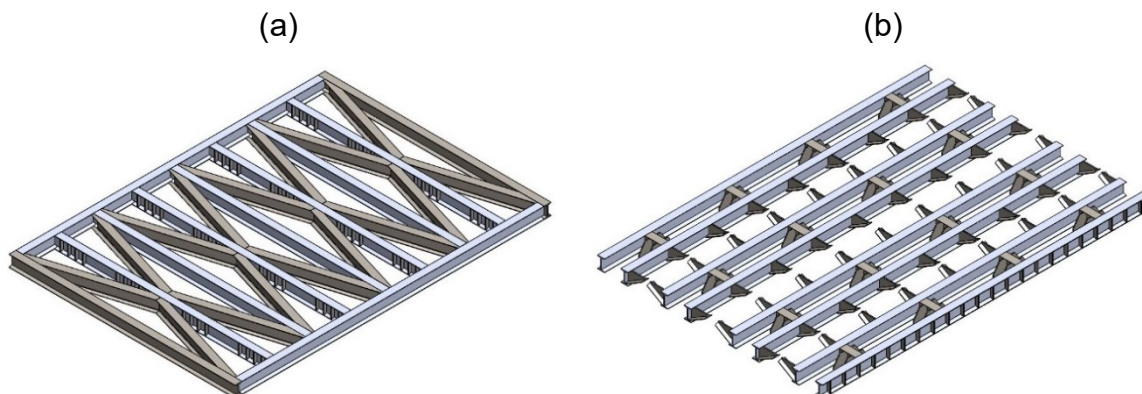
(a) Estrutura Superior e (b) Estrutura Inferior (Autor, 2020)
